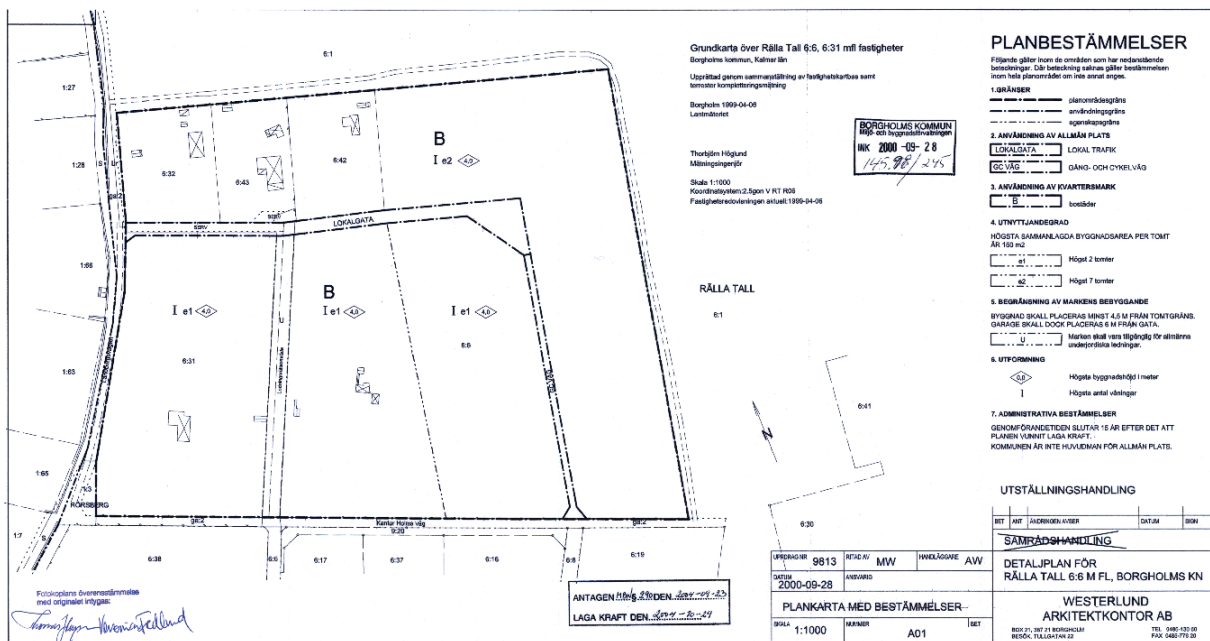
Gällande detaljplan för bebyggelsen utmed Almas väg.
